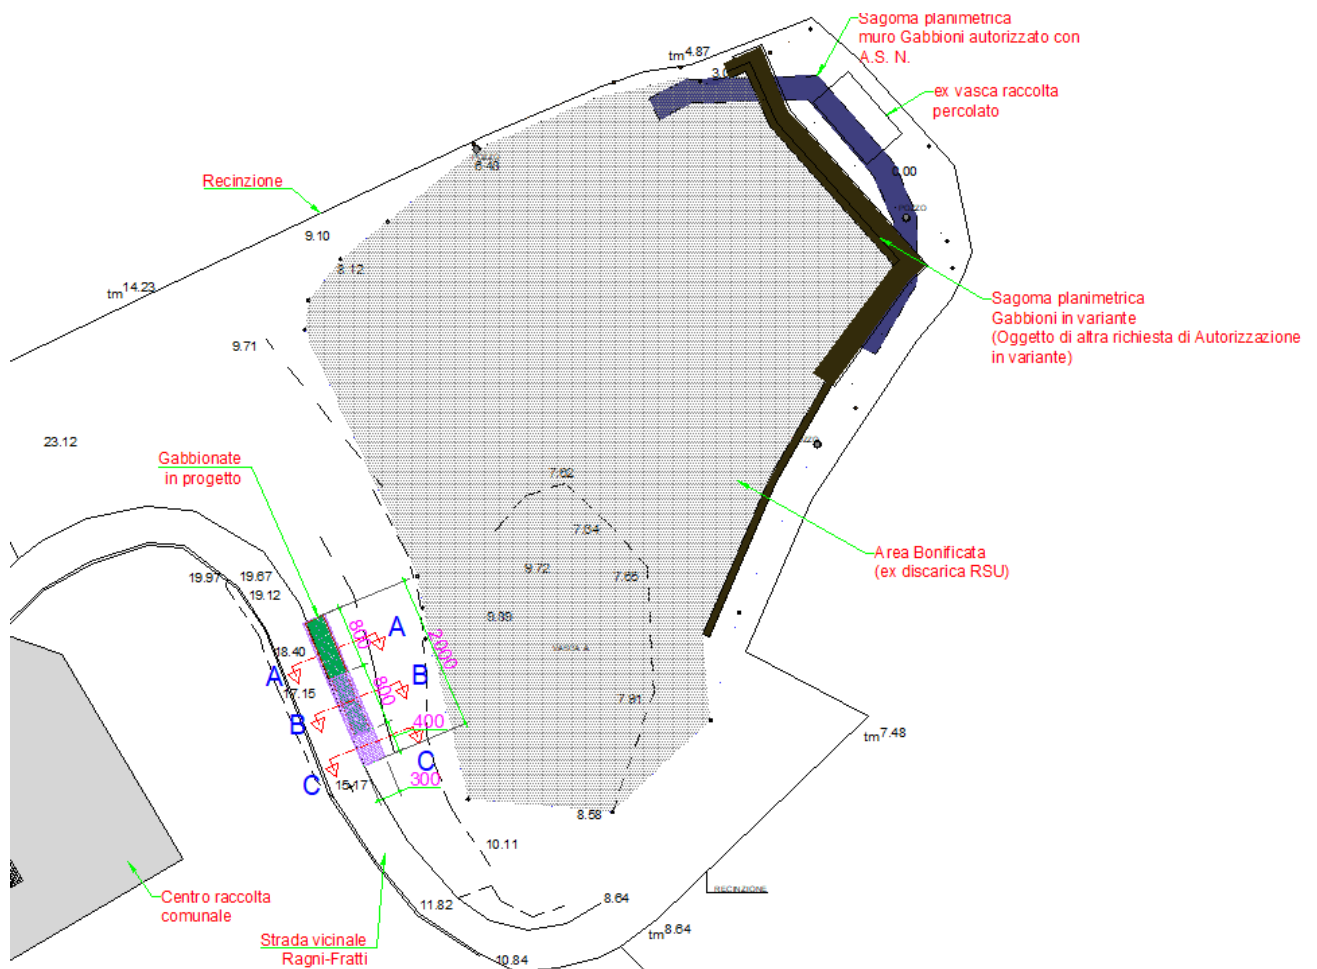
Planimetria generale dell'area, con sviluppo dei muri in progetto
